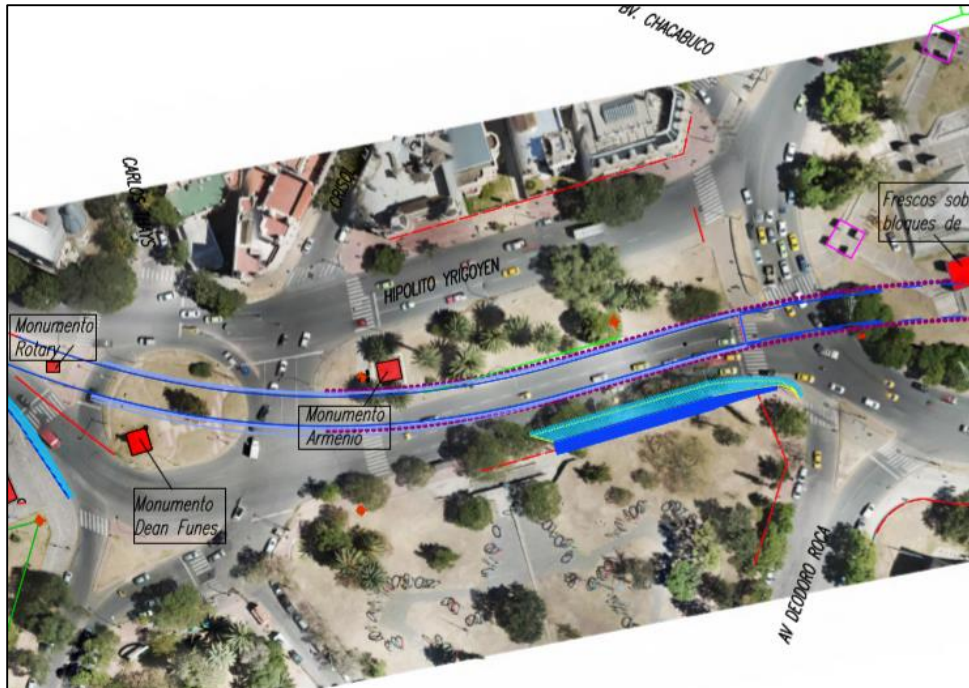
Monumentos existentes en zona de obra. (PLANO N° 9)
